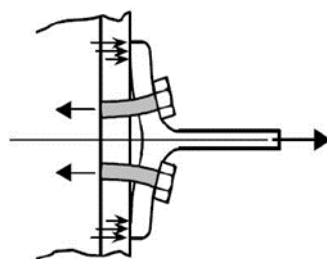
LIGAÇÃO EM PERFIL TIPO T
